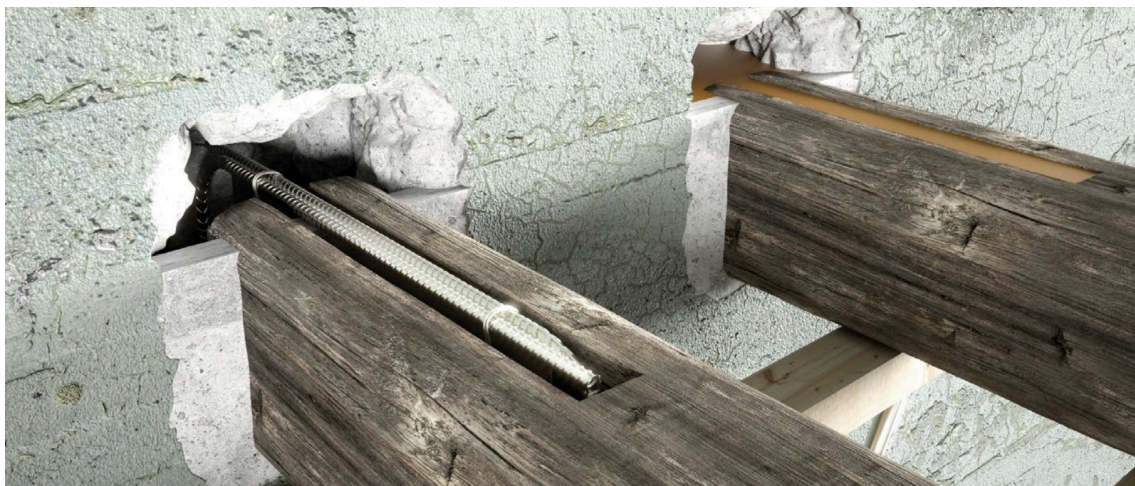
Reforço estrutural de vigas com o uso de varões e colas epoxy
